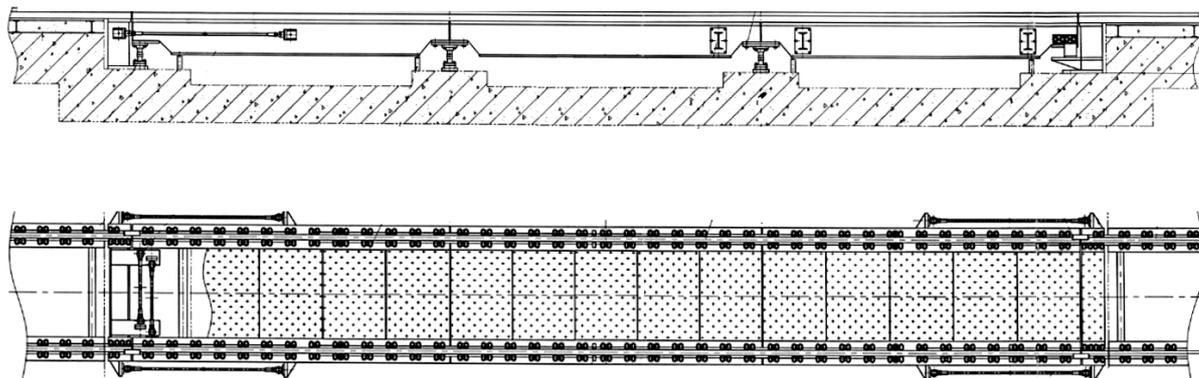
Схема конструкции ГПУ (вид сбоку и вид сверху)
